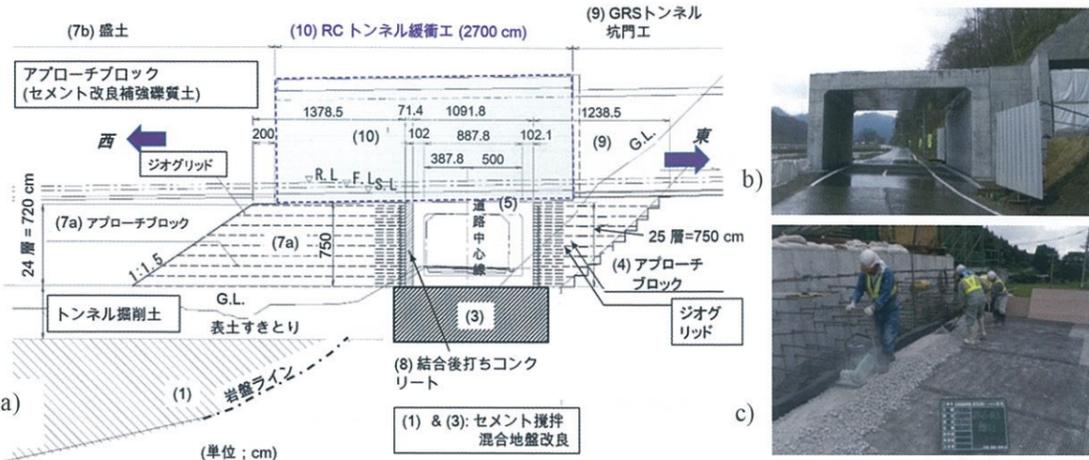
新茂辺地トンネルの坑口付近現場B1のRCボックスカルバート: a) 施工順序(1)～(10)(段階(2)・(6)は示していない), b) 段階(6)後の状況, c) 段階(7a)の施工状況
